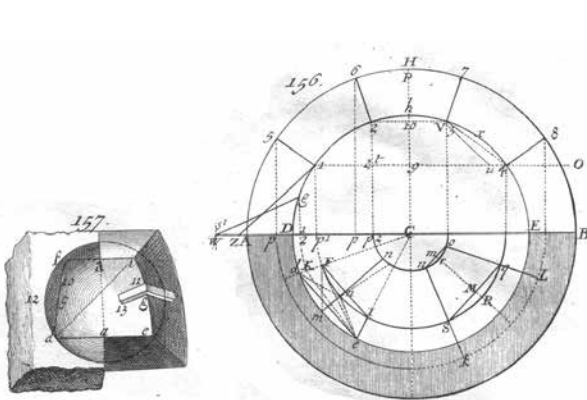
Frézier. Plantilla de la concavidad. Extraído de (Frézier, 1738-1739, tomo II, plancha 53, figs. 156-157)
